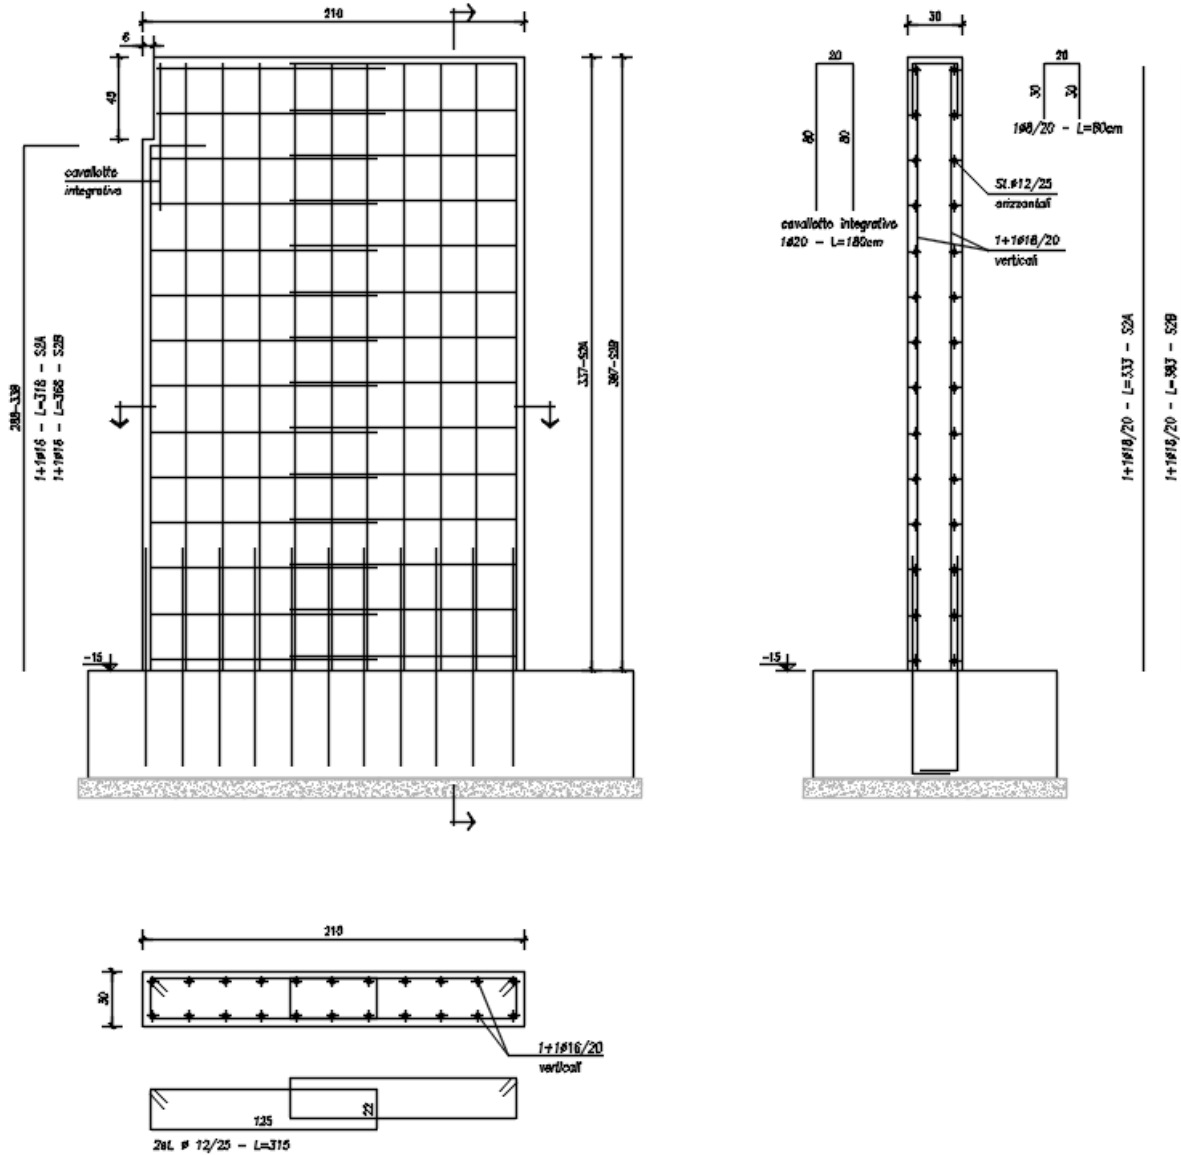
armatura di calcolo muri elevazione B210xsp.30cm
